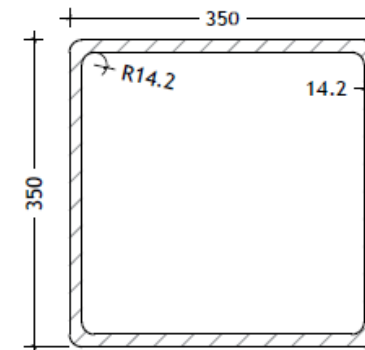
Sección Sección de las vigas longitudinales en mm.
